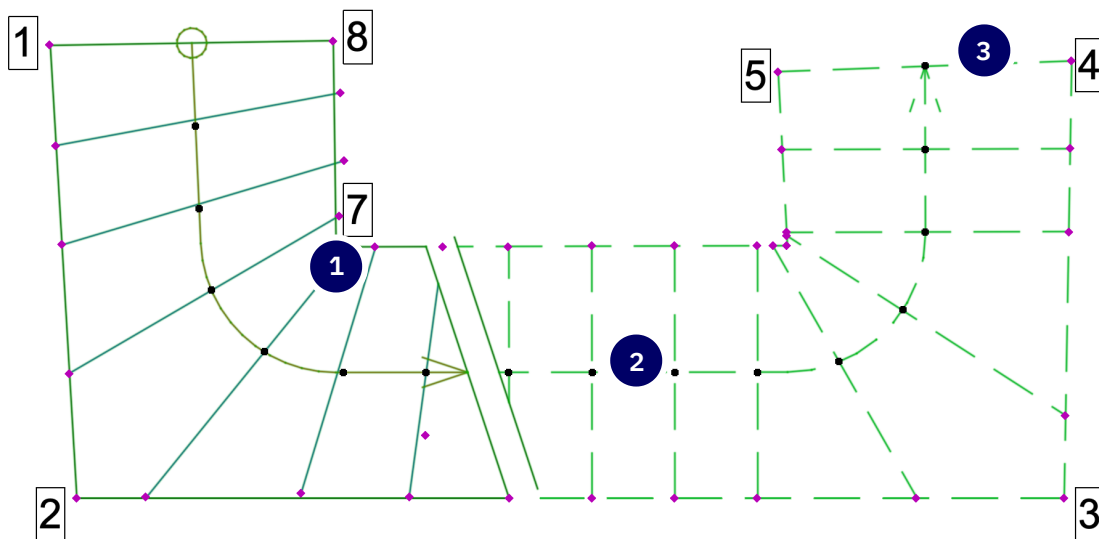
· Grundriss mit den Konturpunkten 1–8, Lauflinie vom Antrittskreis bis zum Austrittspfeil.
